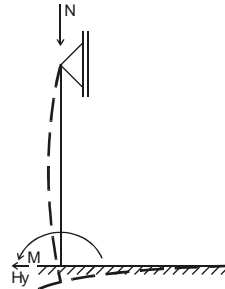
Statisches Modell für die Berechnung mit Stahlbetonwand (Es entsteht Zug auf der Außenseite)
